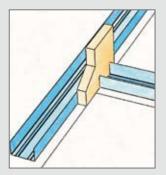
Espace entre rails permettant la pose des plaques de parement pour jonction en T ou en L
